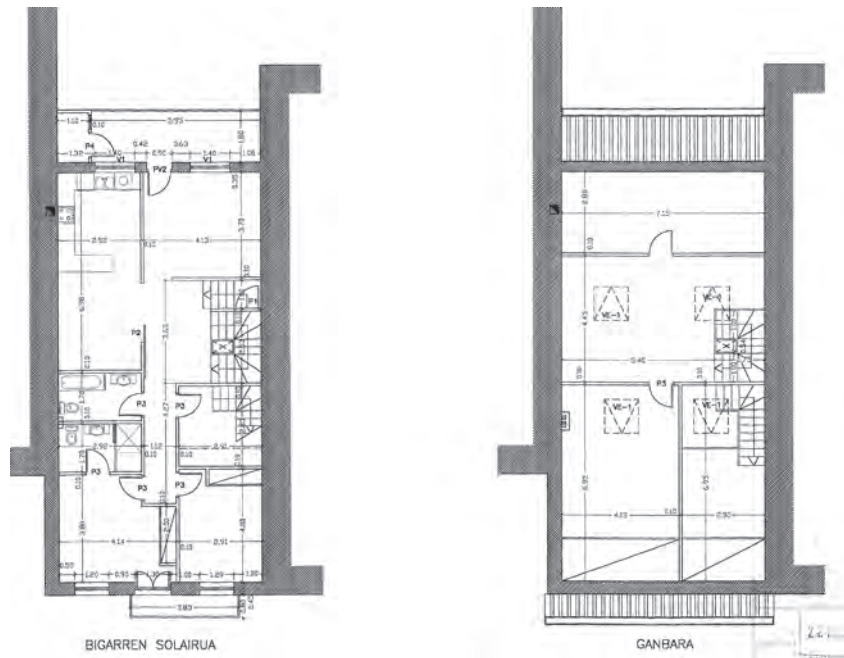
18. 2002 PLANTA SEGUNDA Y BAJOCUBIERTA PROPUESTA
